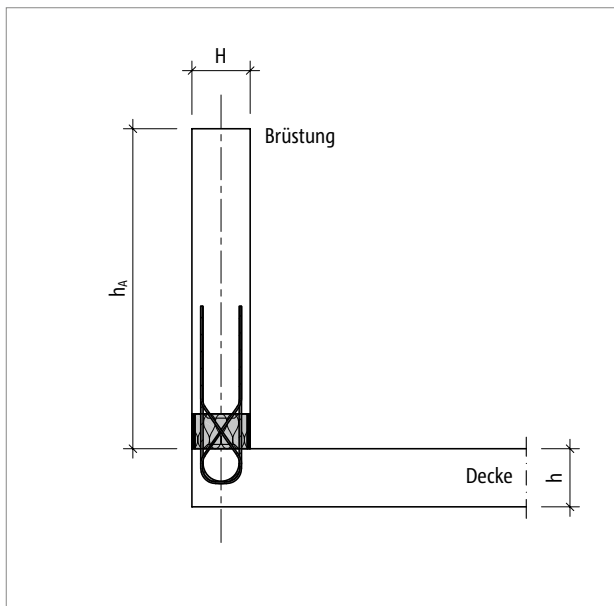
Schöck Isokorb® XT Typ AP: Statisches System Brüstungshöhe h_A
